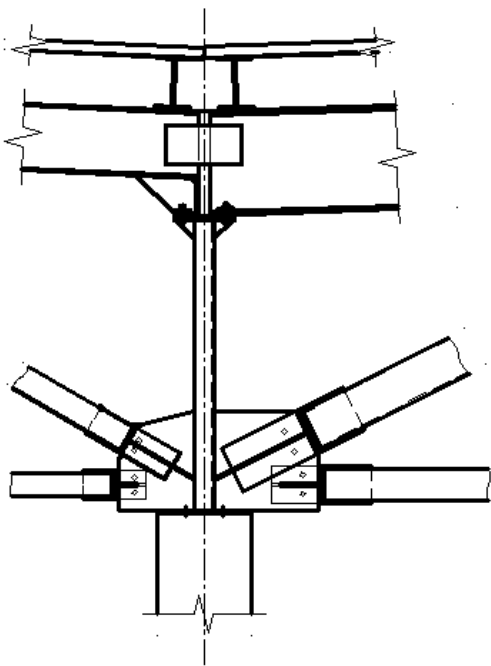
Узел опирания стропильных конструкций на колонну
